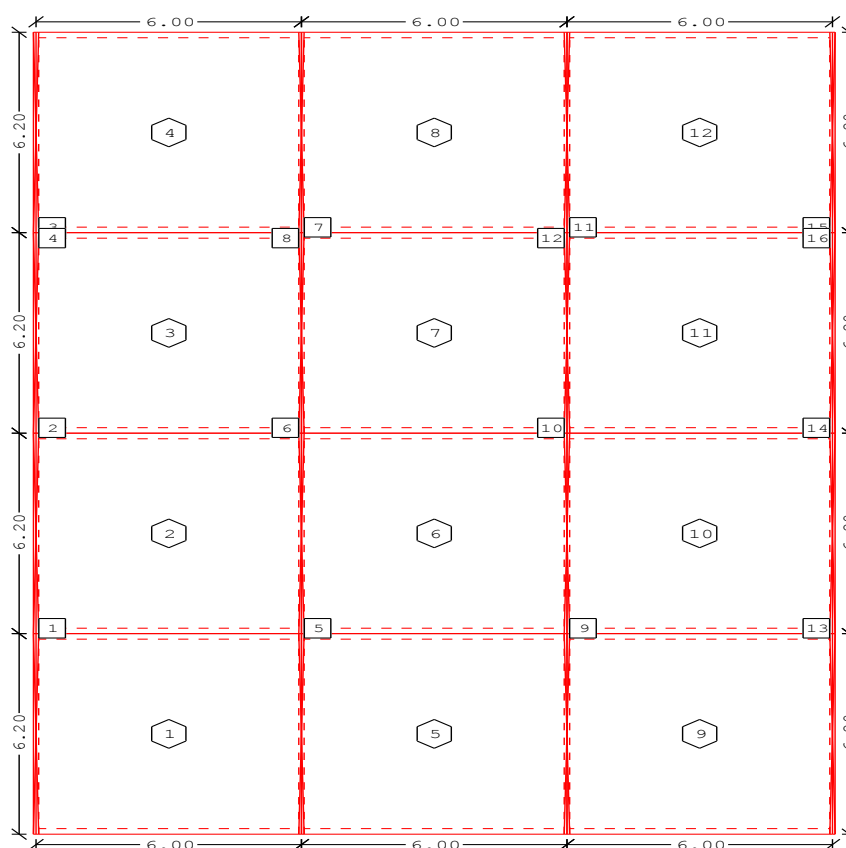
Расчетная схема монолитного перекрытия
